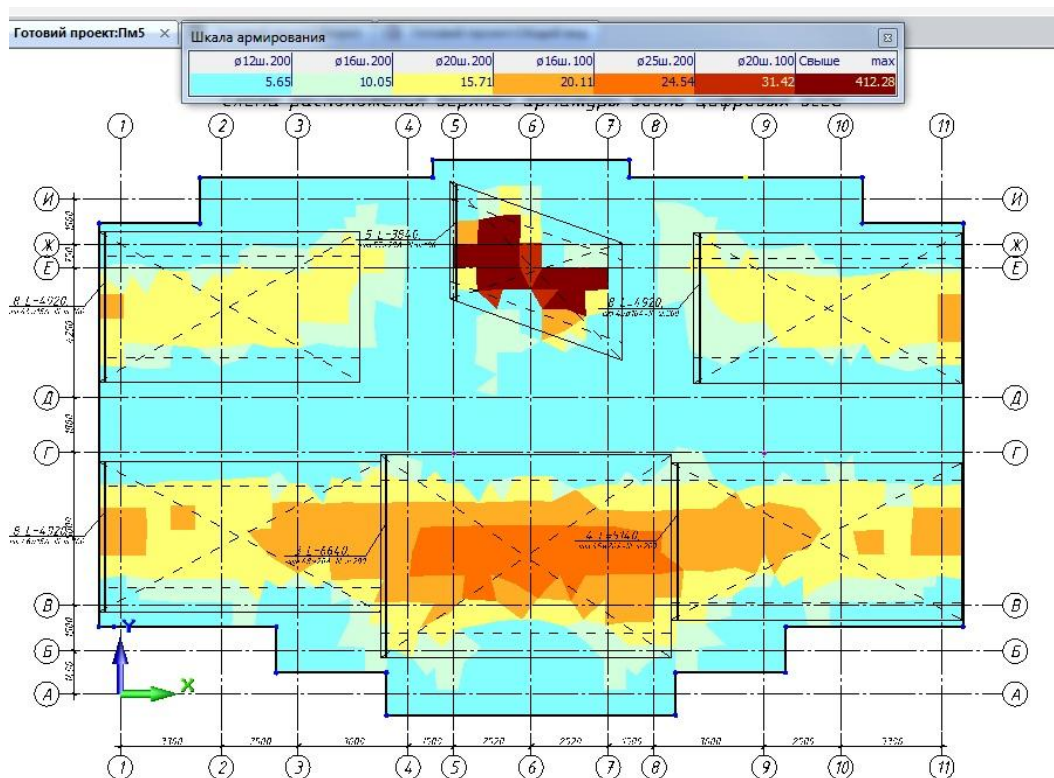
Армування нижньої зони фундаментної плити по осі X
